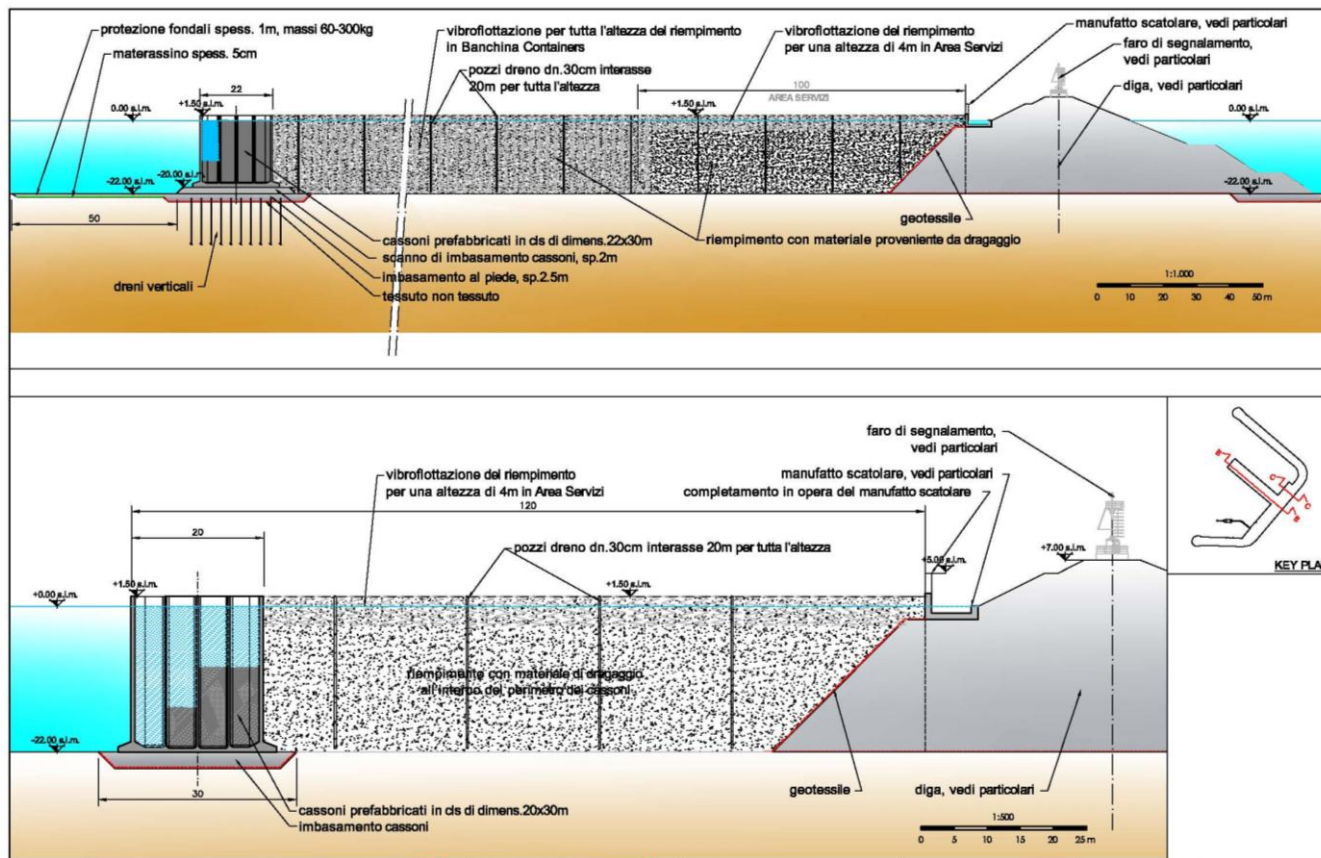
Banchina servizi – vibroflottazione del terrapieno di riempimento
